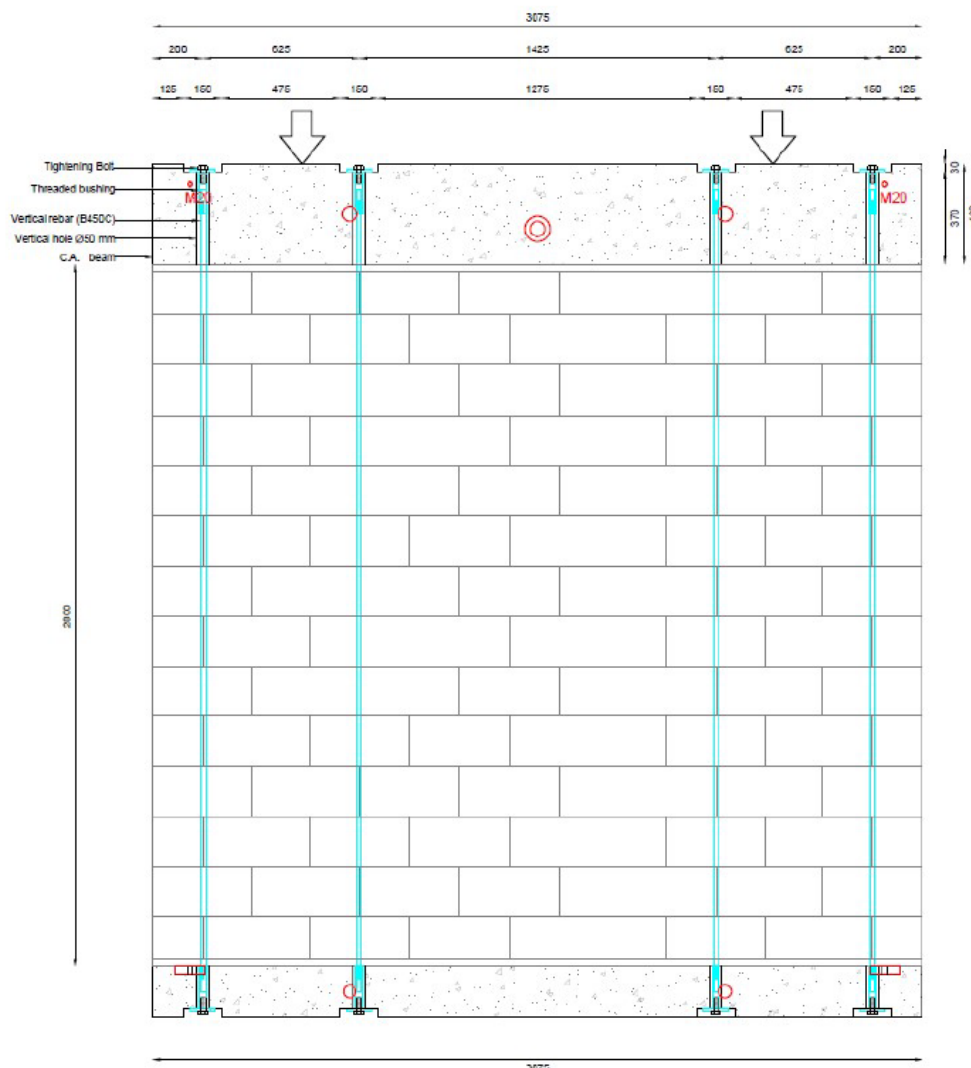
Dettaglio disposizione armatura verticale sui provini.
